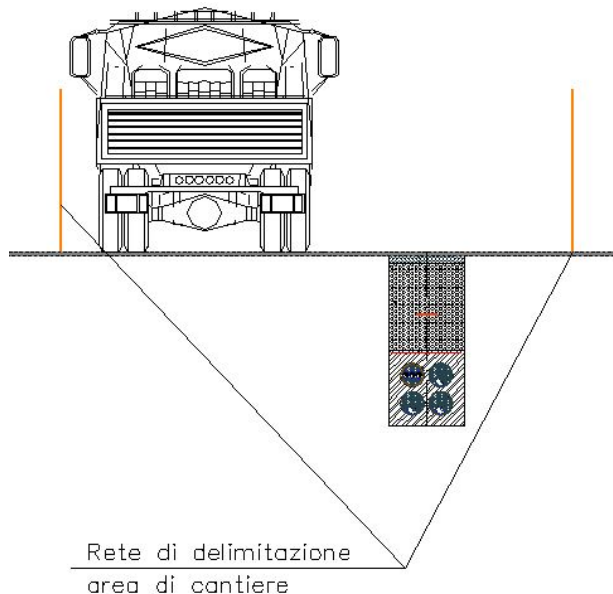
Sezione tipo area di cantiere per un cavidotto
